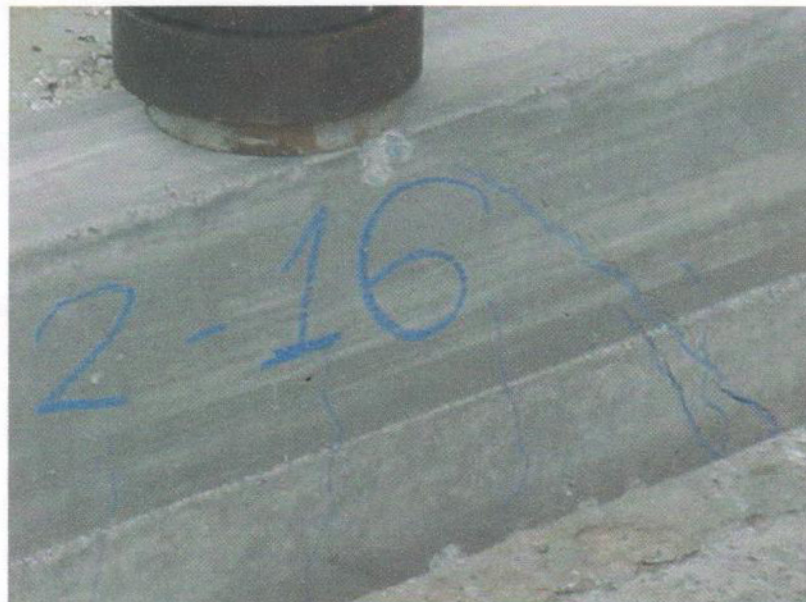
Ocorrência de fissuras durante o ensaio (Amostra 02 – concreto Fck 16Mpa).
